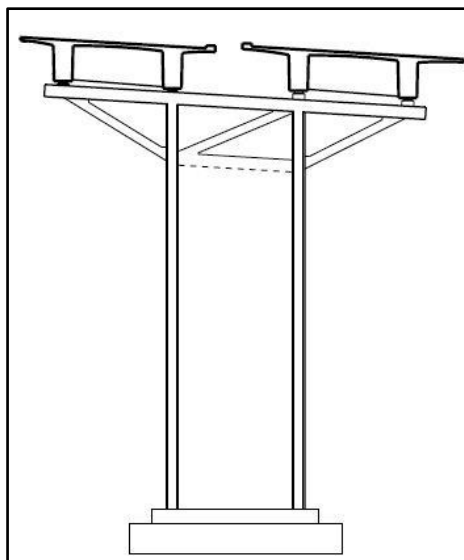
Perfil transversal de um pilar e respectivos tabuleiros [20]
